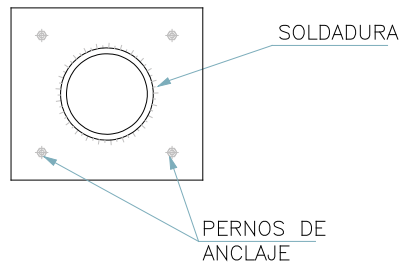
Detalle placa de apoyo. Elaboración propia.
